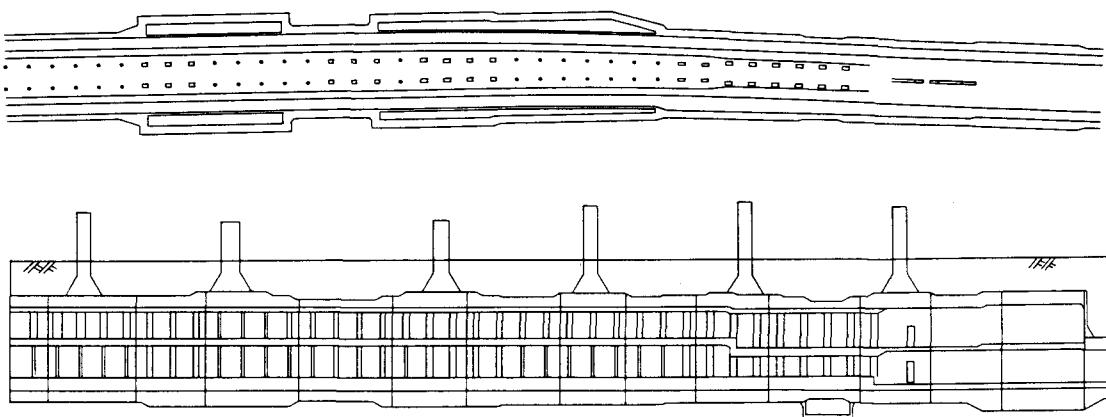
適用対象工事（地下鉄駅部工事）の平面図および側面図
